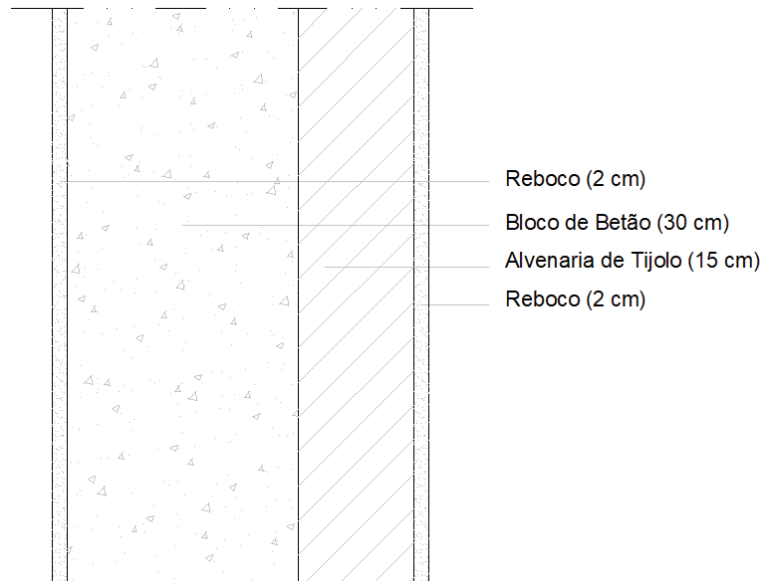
Pormenor construtivo da parede interior tipo XVIII (elevador)
